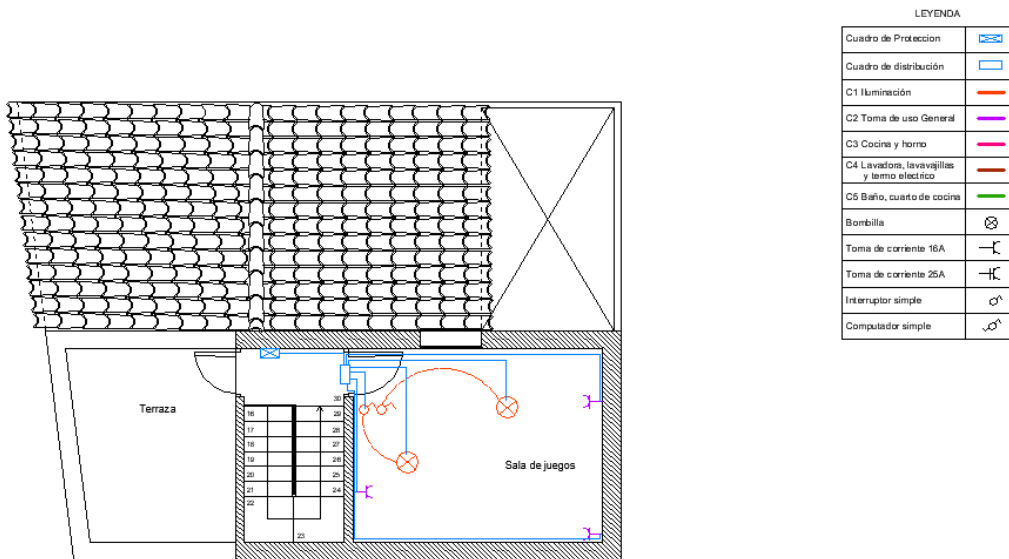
Croquis de sistema eléctrico planta dos. Fuente propia
